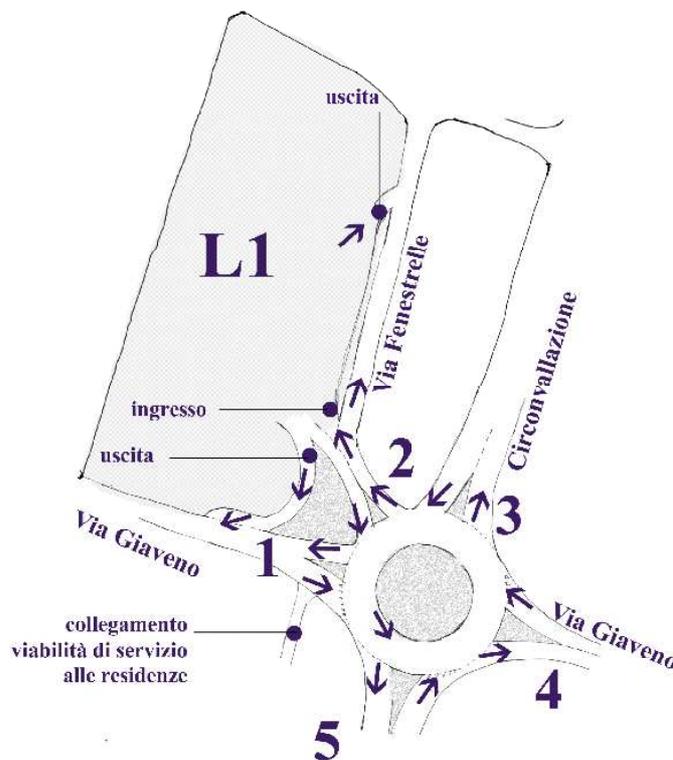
Revisione della rotondina di Via Giaveno: ipotesi 1
